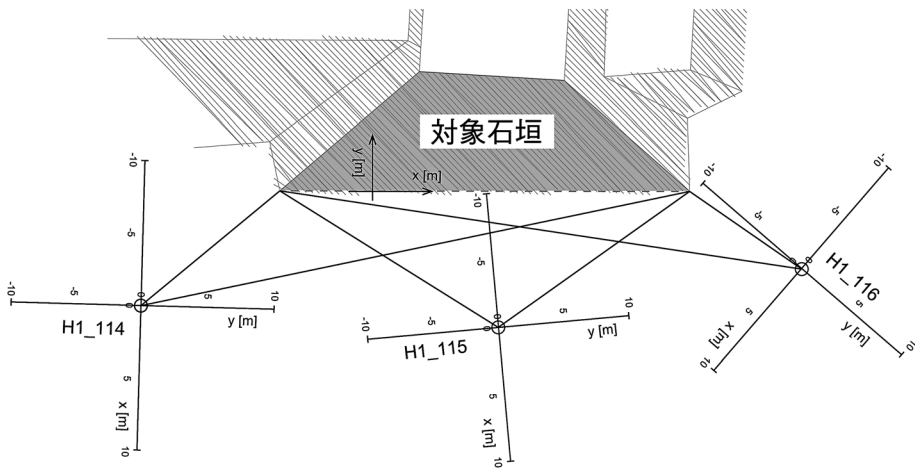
石垣と計測位置の平面図 (櫓方三階櫓の石垣)
